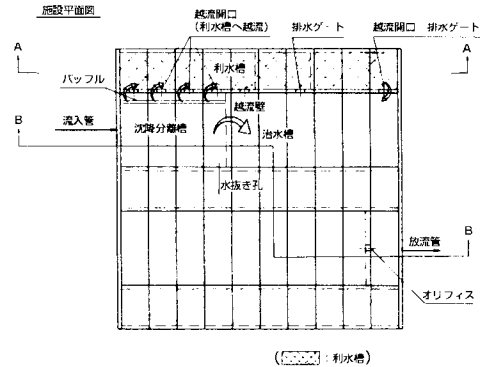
分離雨水の沈降分離型貯留施設の構造概要図
